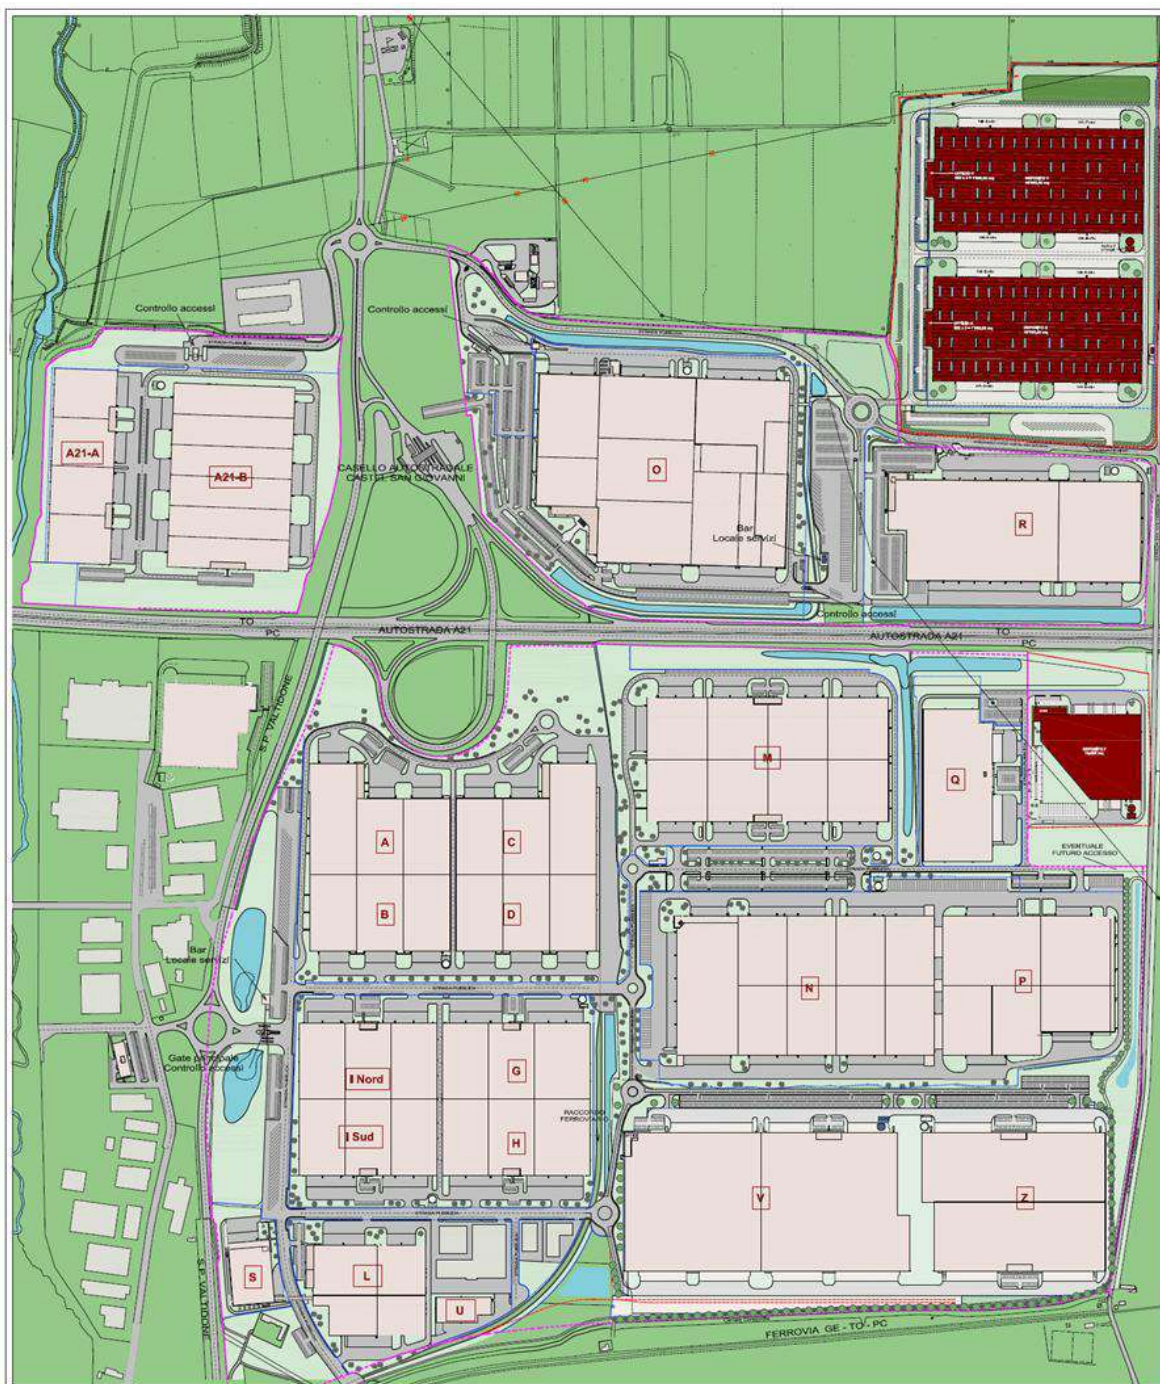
Localizzazione dell'ampliamento previsto di FASE 6. Planimetria
